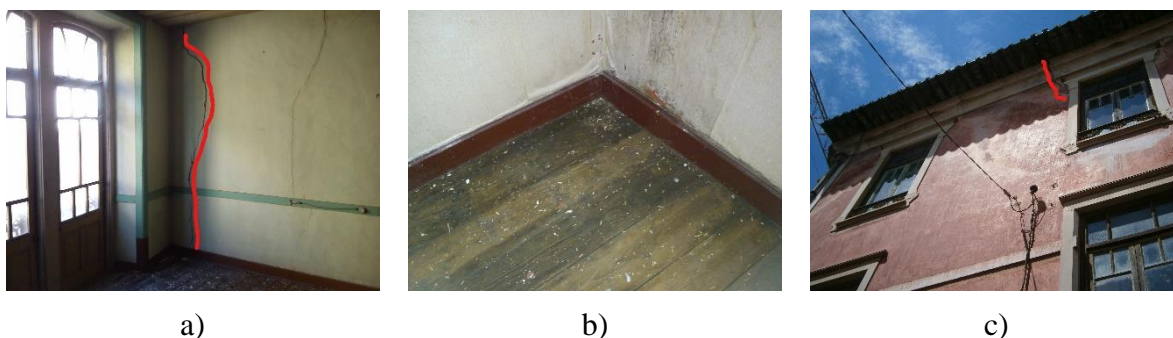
Patologias estruturais observadas: a) fissuração em cunhal; b) humidade na estrutura de pavimento; c) fissuração devido a impulso horizontal
